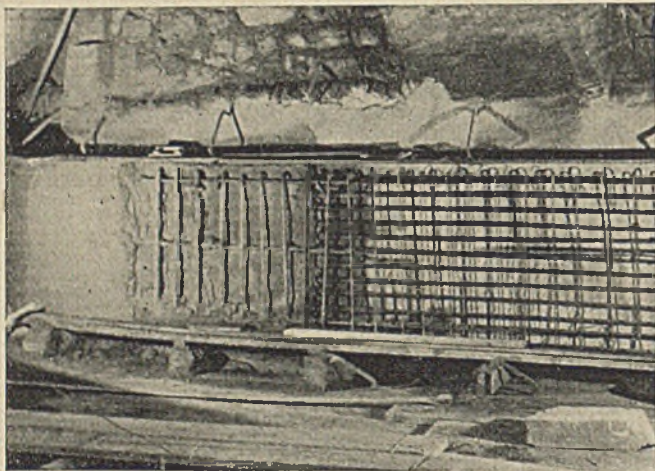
Ausführung des Eisenbetonankers in Tambourhöhe durch Torkretierung.
